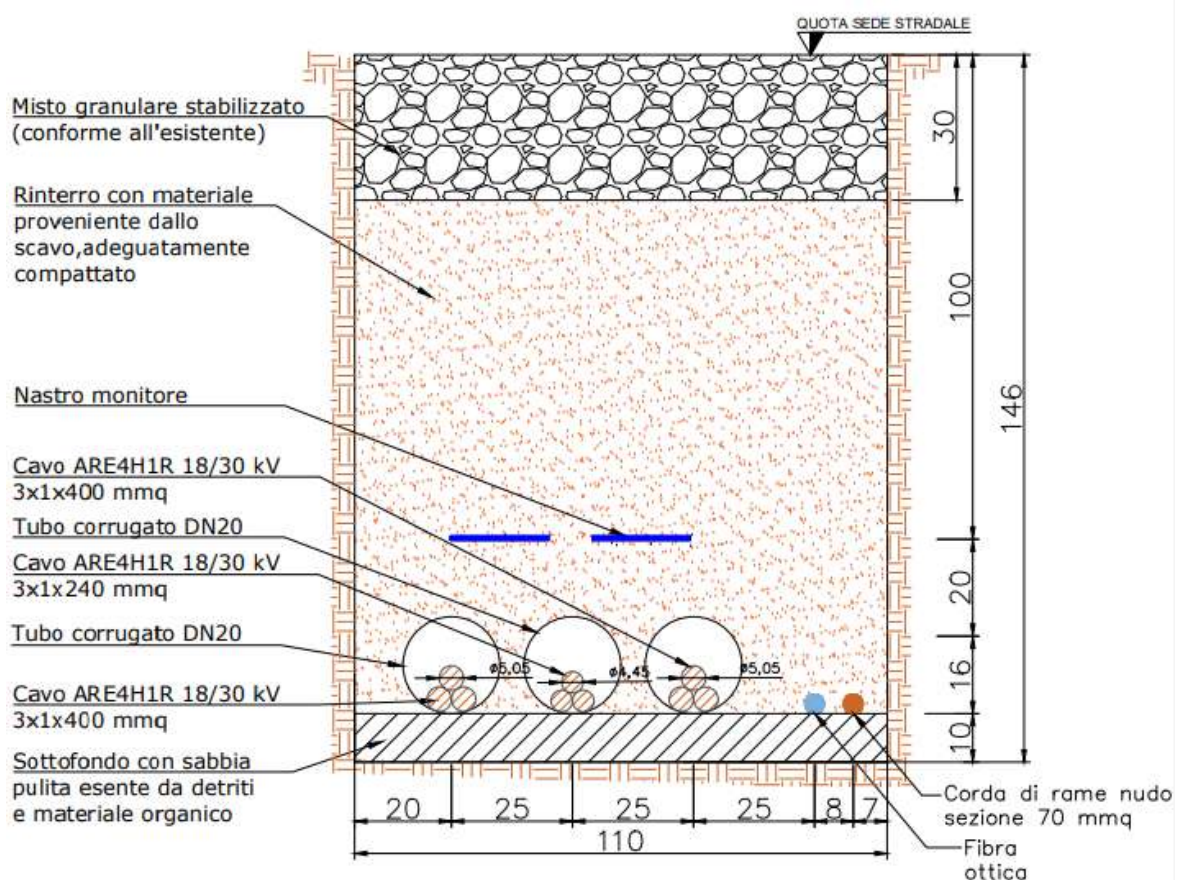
Sezione cavidotto MT composto da tre terne di cavi a 30 kV su strada asfaltata
